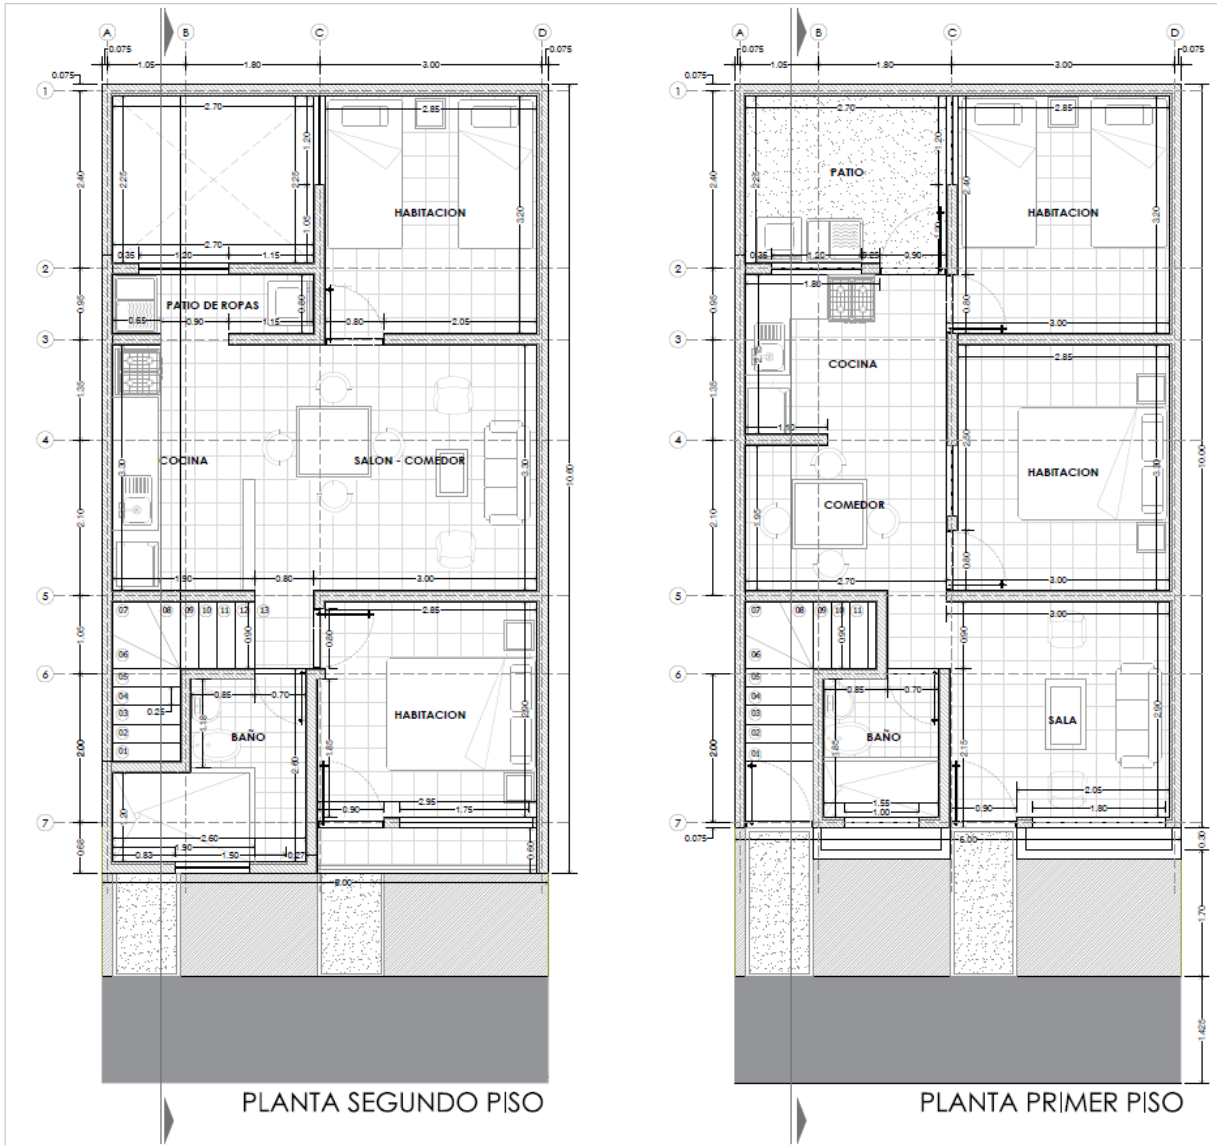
Plantas arquitectónicas de vivienda bifamiliar tipo. Fuente: Autores.
